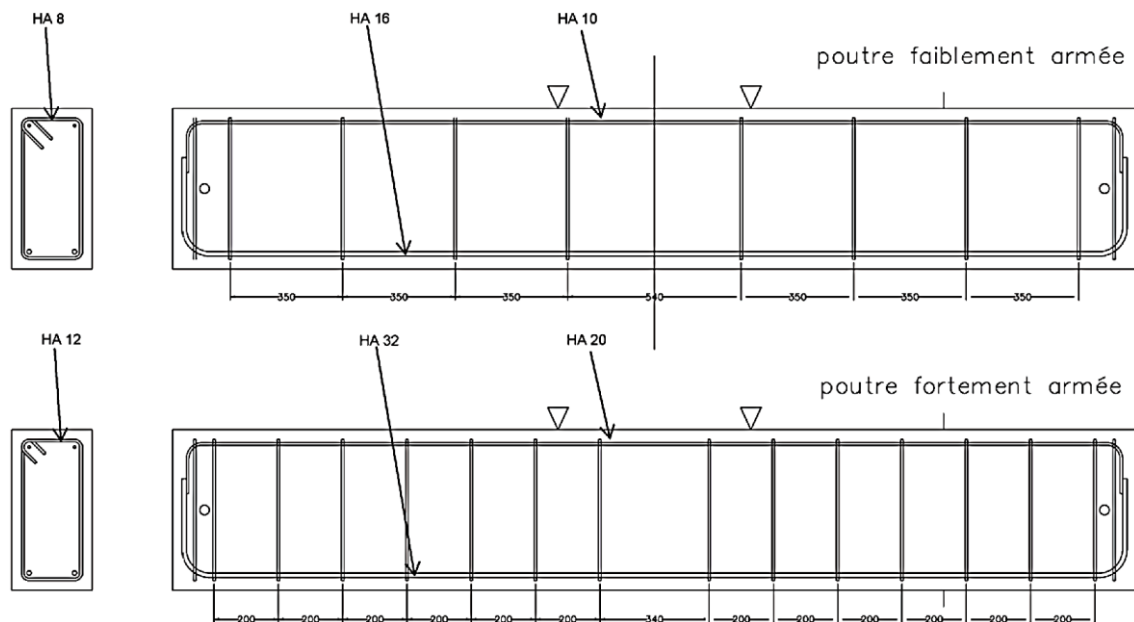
Plans de ferrailage des poutres faiblement armée et fortement armée (Martin, 2010).
